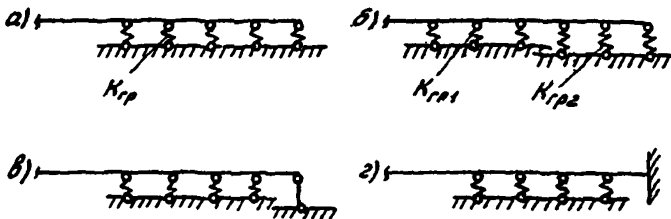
Варианты схем опирания трубы на грунт (элементы расчетной схемы):
